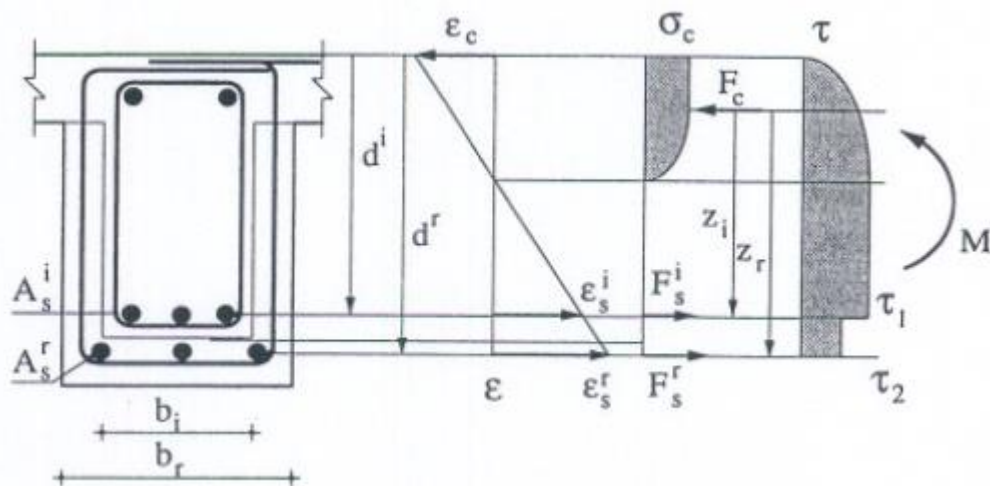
Modelo de cálculo para verificação da ligação betão existente/betão novo. (Gomes, A., Appleton, J.)
